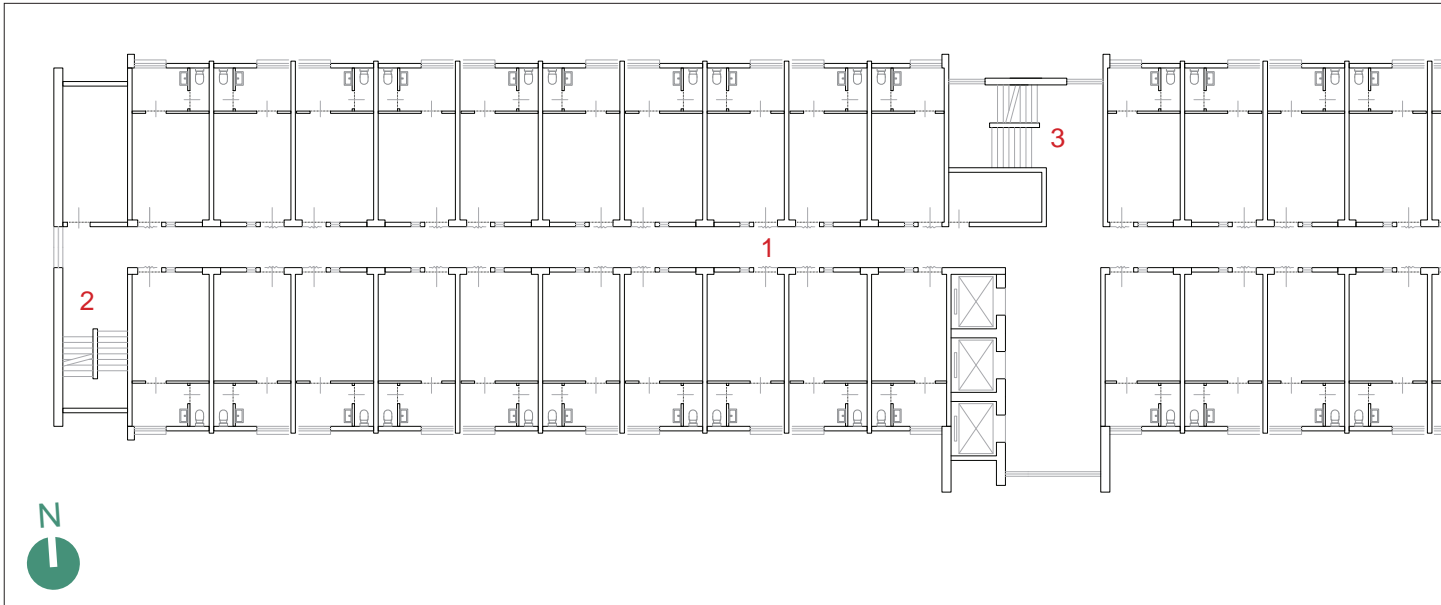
Grundrissplan - Regelgeschoss - Ming Wah Dai
